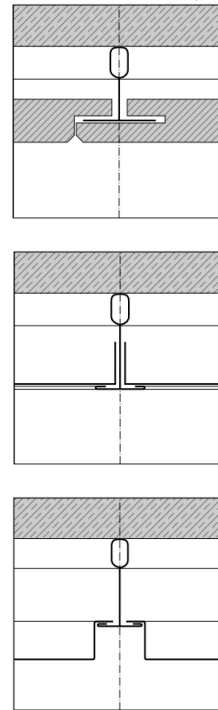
Deckenplattenstoß gefalzt und genutet (oben), Deckenelementstoß in Unterkonstruktion eingelegt (Mitte), Deckenelementstoß in Unterkonstruktion eingelegt mit Stufenfalz (unten)⁴²
